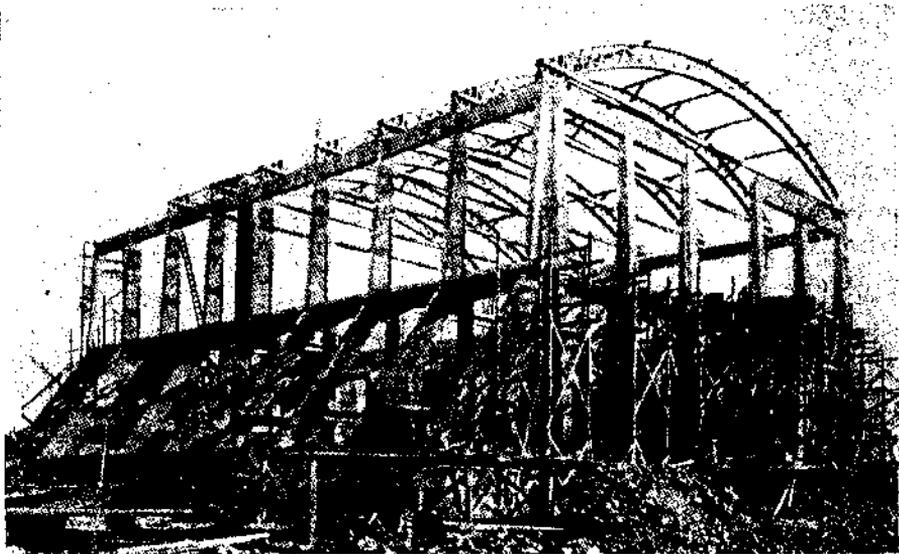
Центральный вокзал в Копенгагене, перекрытый фермами Стефан, шесть пролетов по 25 м каждый; затяжки металлические.
